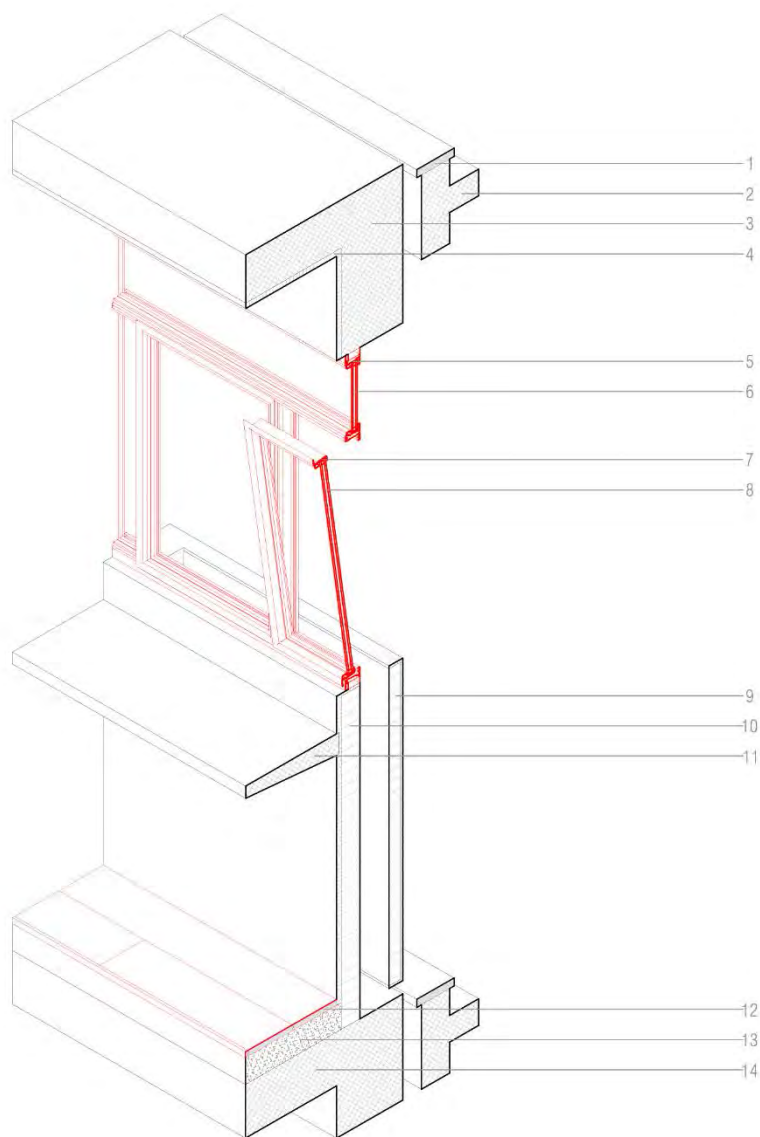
Pormenor Construtivo em axonometria do vão presente no quarto orientado a poente sobre a galeria de serviço
